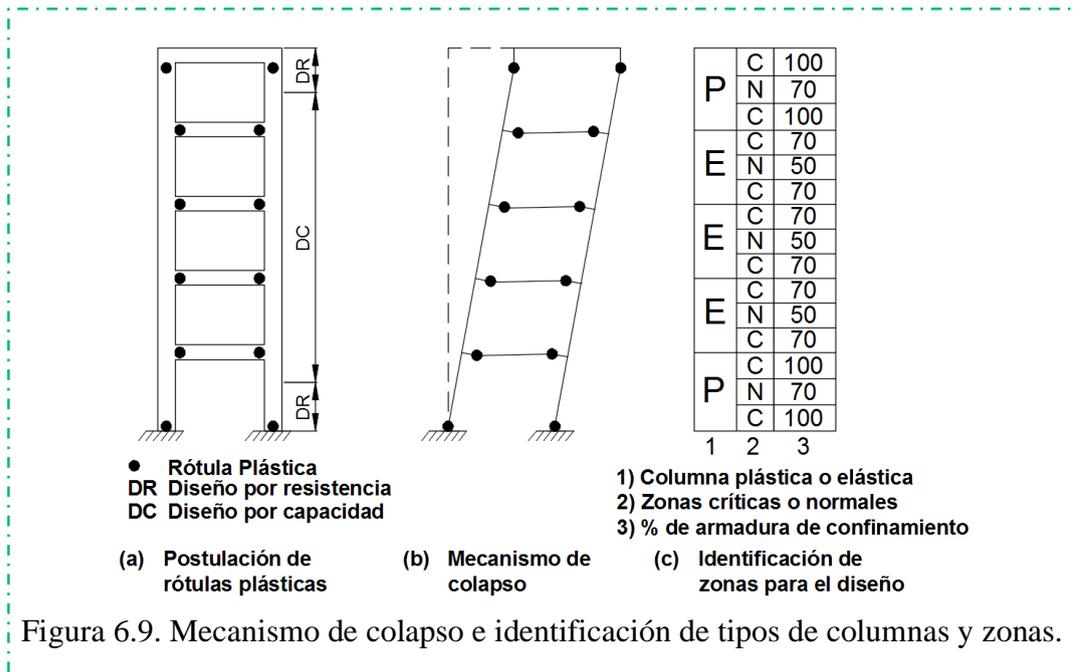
Mecanismo de colapso e identificación de tipos de columnas y zonas.
